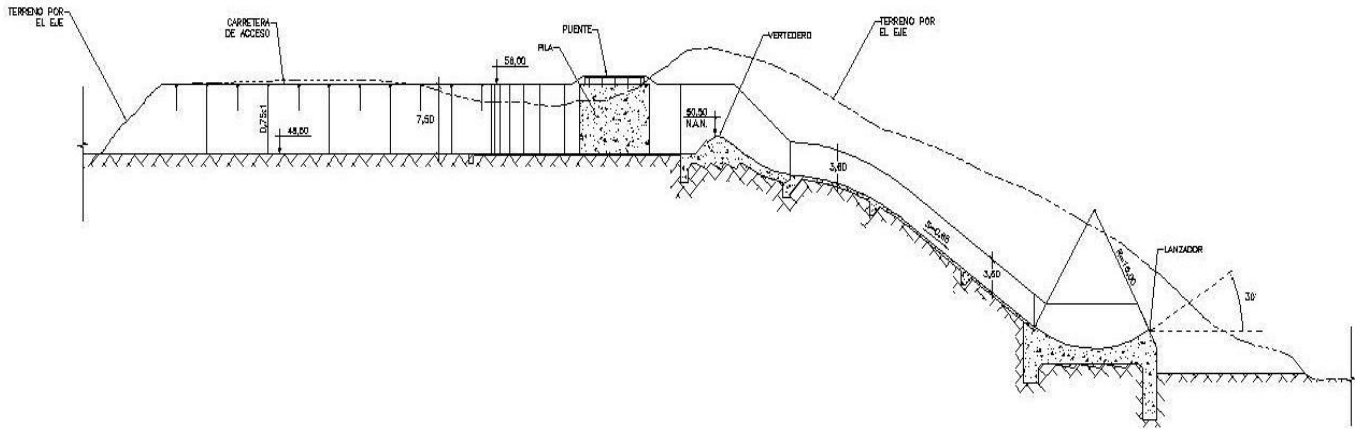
Perfil Longitudinal del Nuevo Aliviadero
